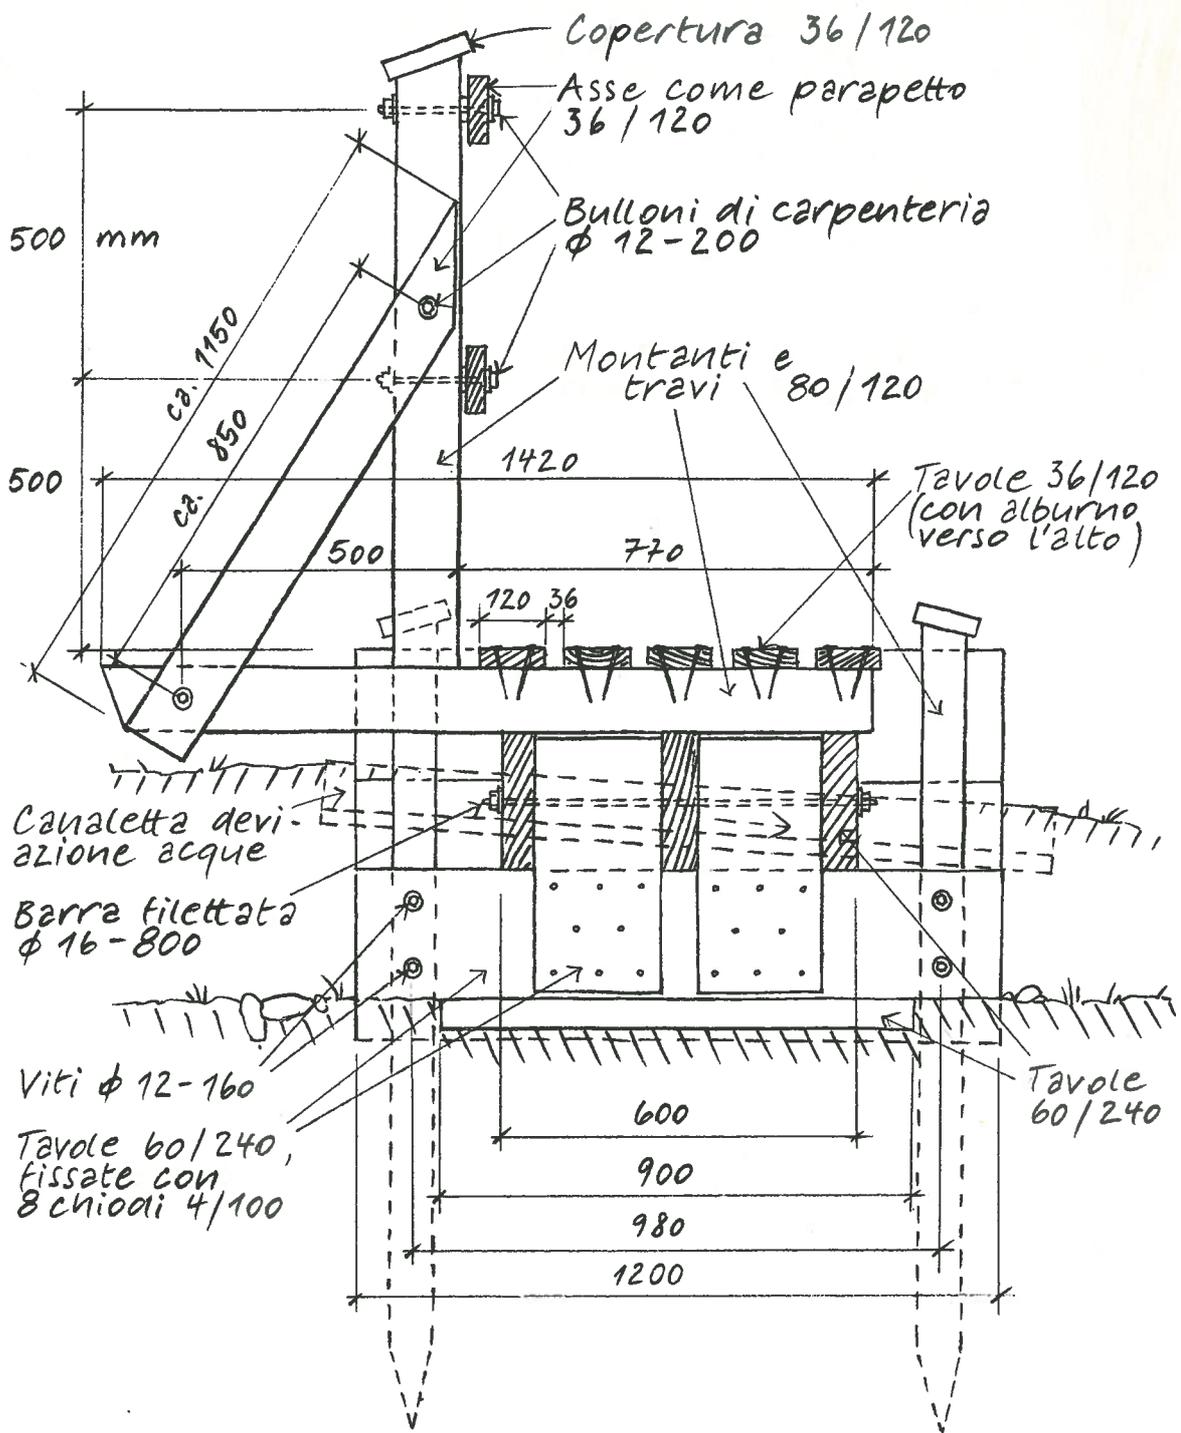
13 d: Passerella con legname segato, esecuzione standard; sezione B-B
